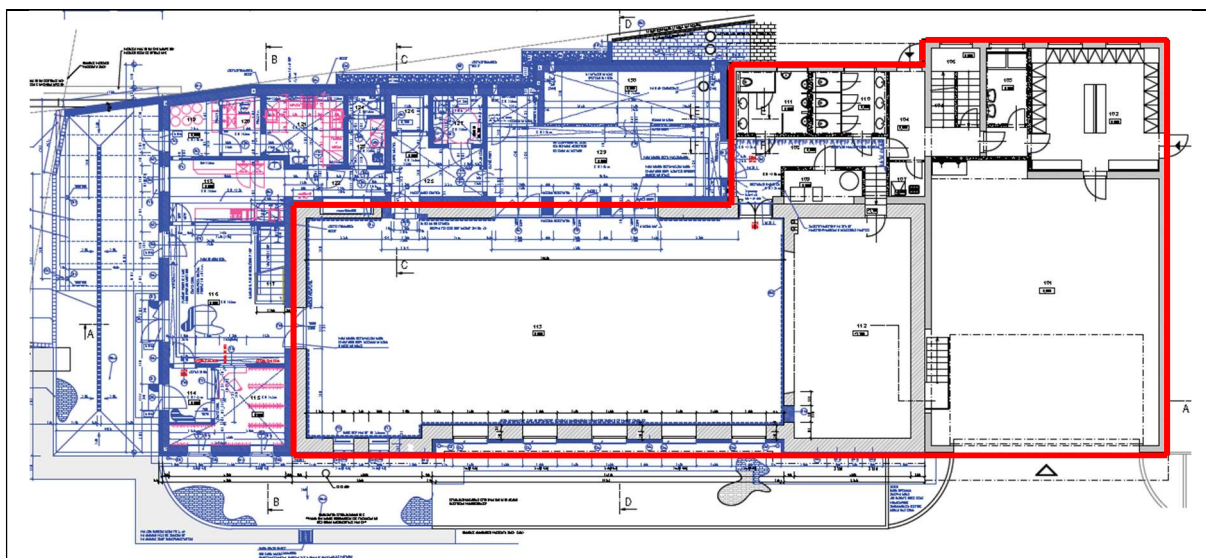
Půdorys z výkresu č. 18 Základy přístavby – typická část základů před štitovou stěnou, [2]
